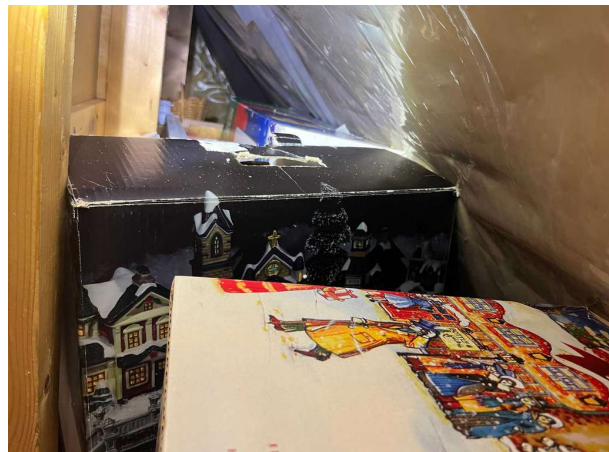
Invändigt, Plan 1, Utrymmena var vid besiktningstillfället belamrade varför det ej gått att kontrollera på ett fullg...
